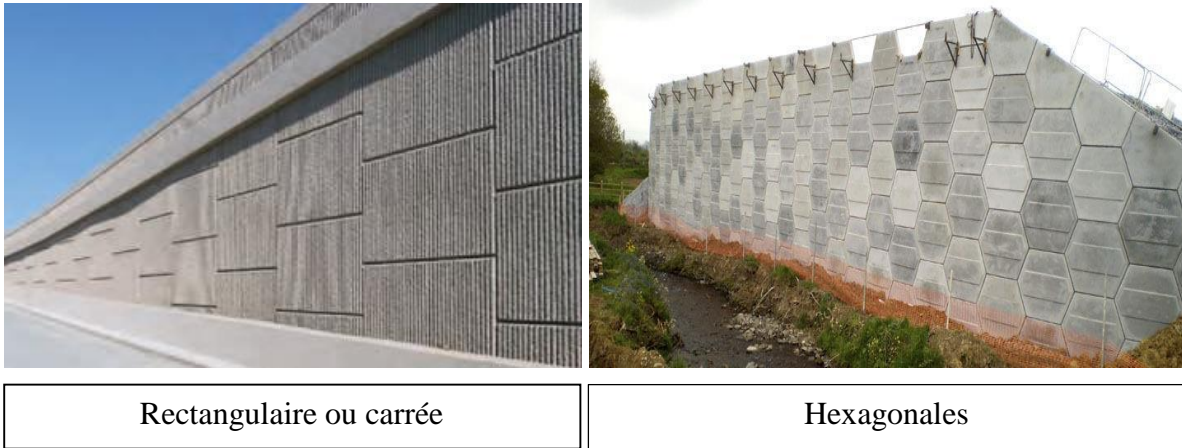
4 : Panneaux de hauteur partielle (Terre Armée)
